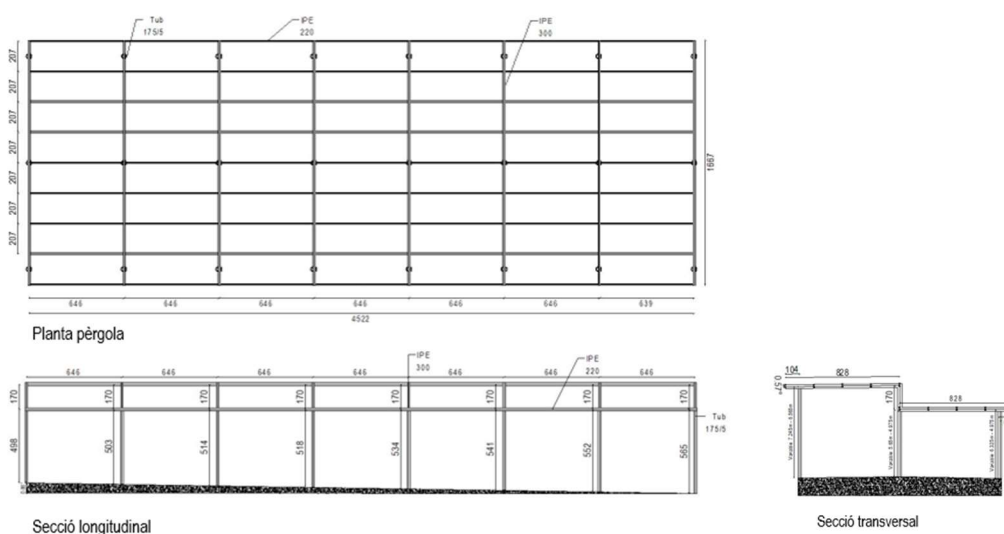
Planta, alçat i secció de l'estructura principal de la pèrgola.
